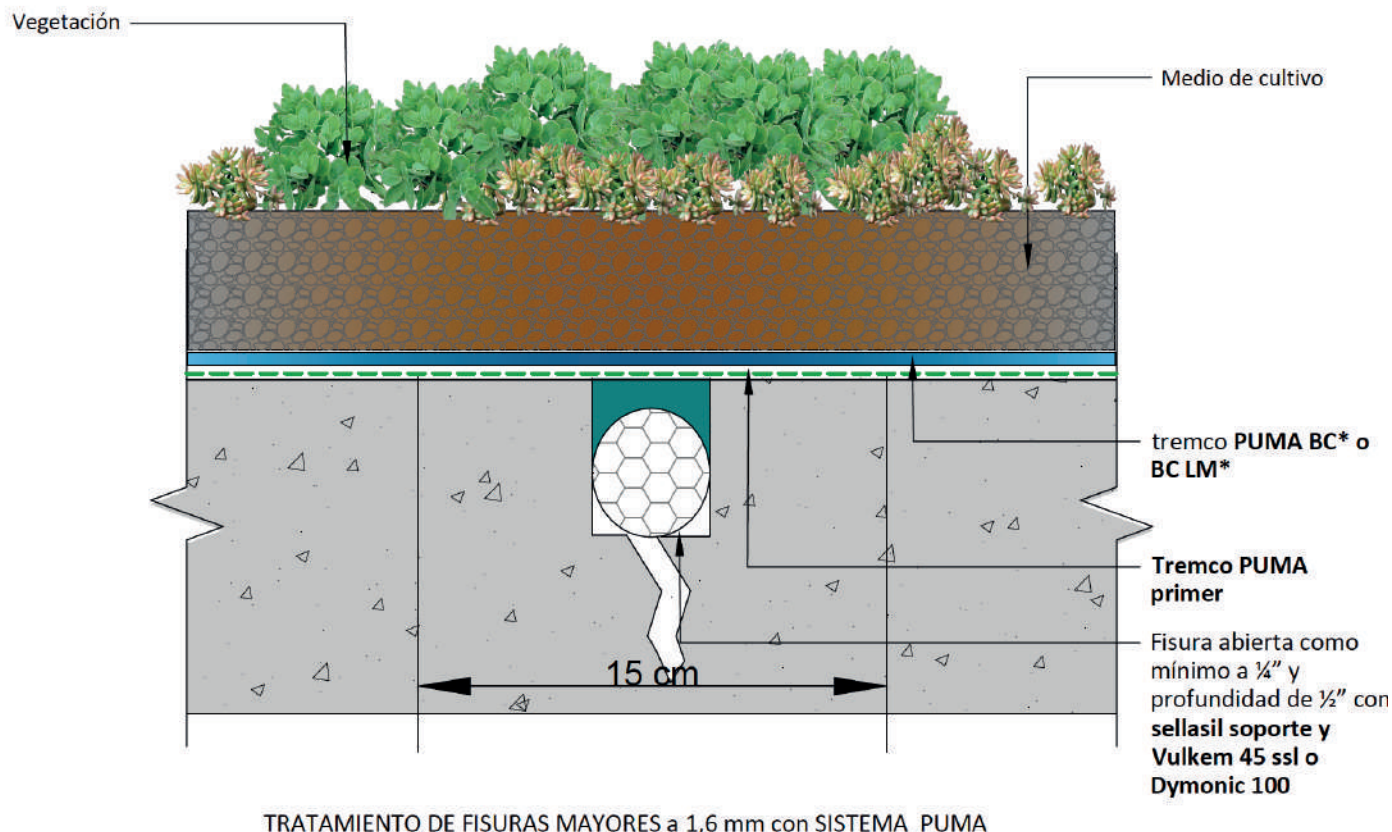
Tratamiento de fisuras mayores a 1.6 mm con el sistema TREMproof® PUMA
